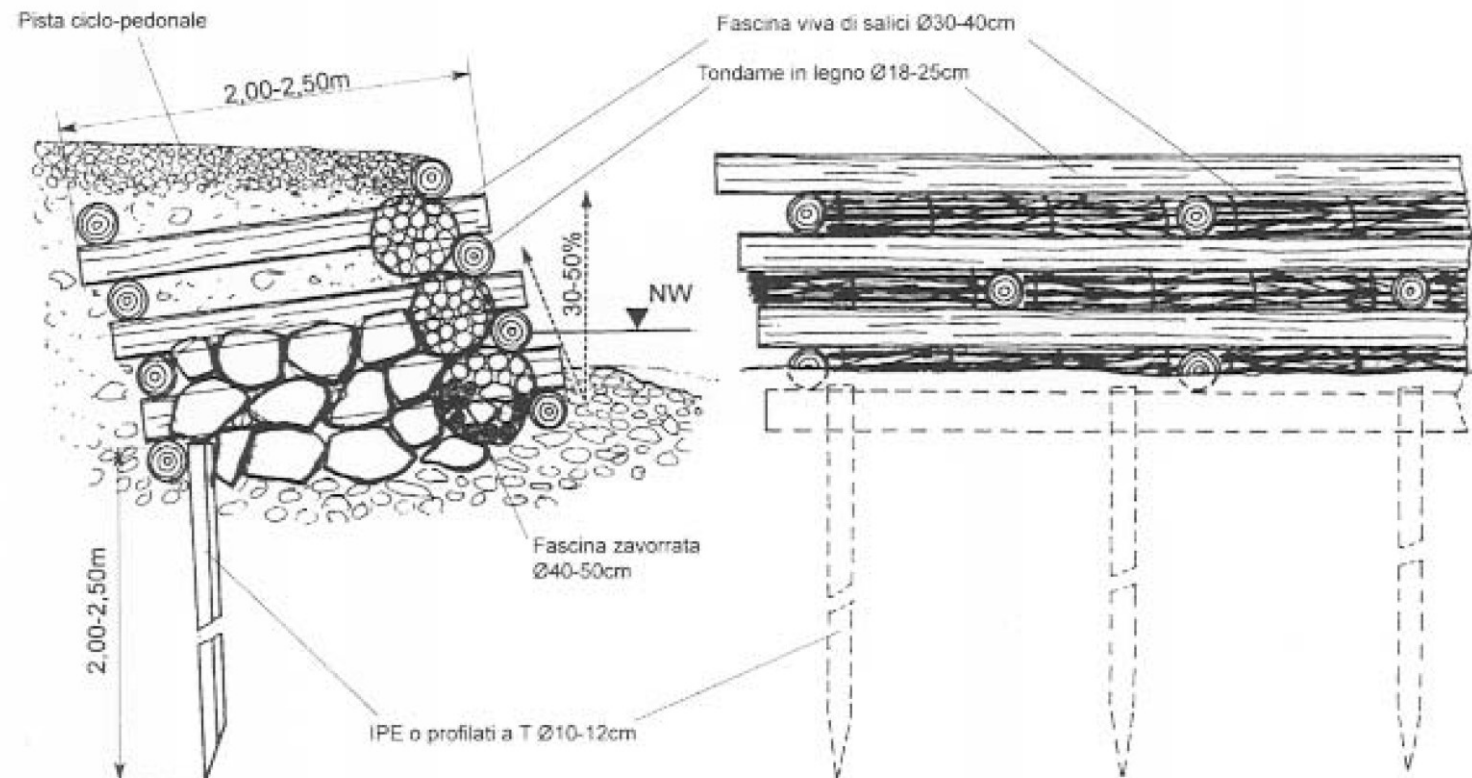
Palificata spondale a parete doppia con fondo antidilavamento
